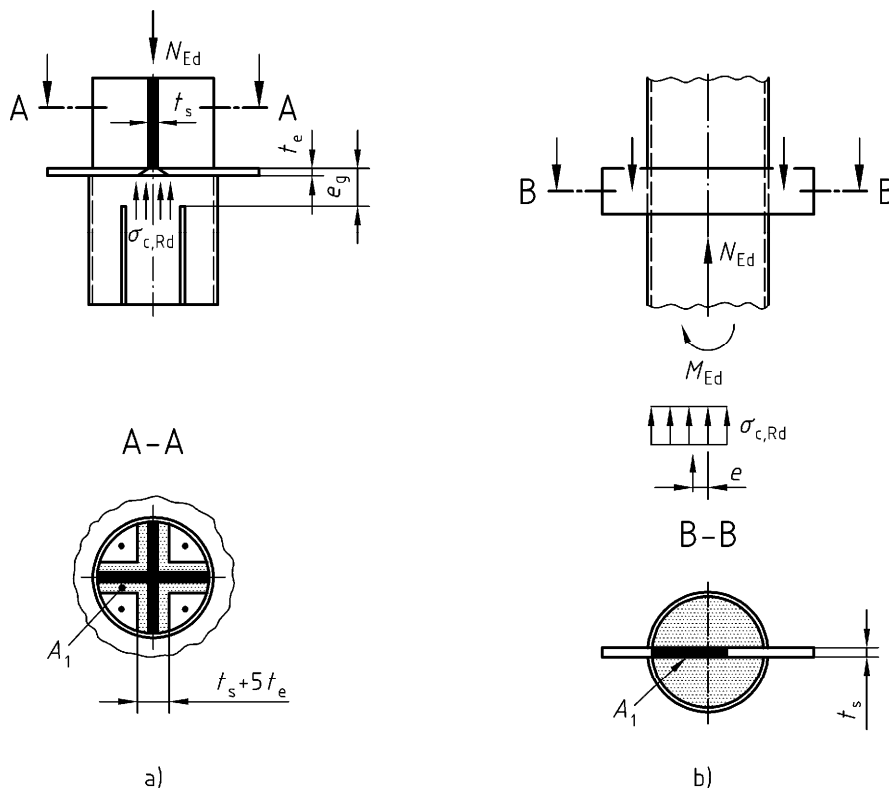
Teilflächenpressung bei ausbetonierten Hohlprofilen
